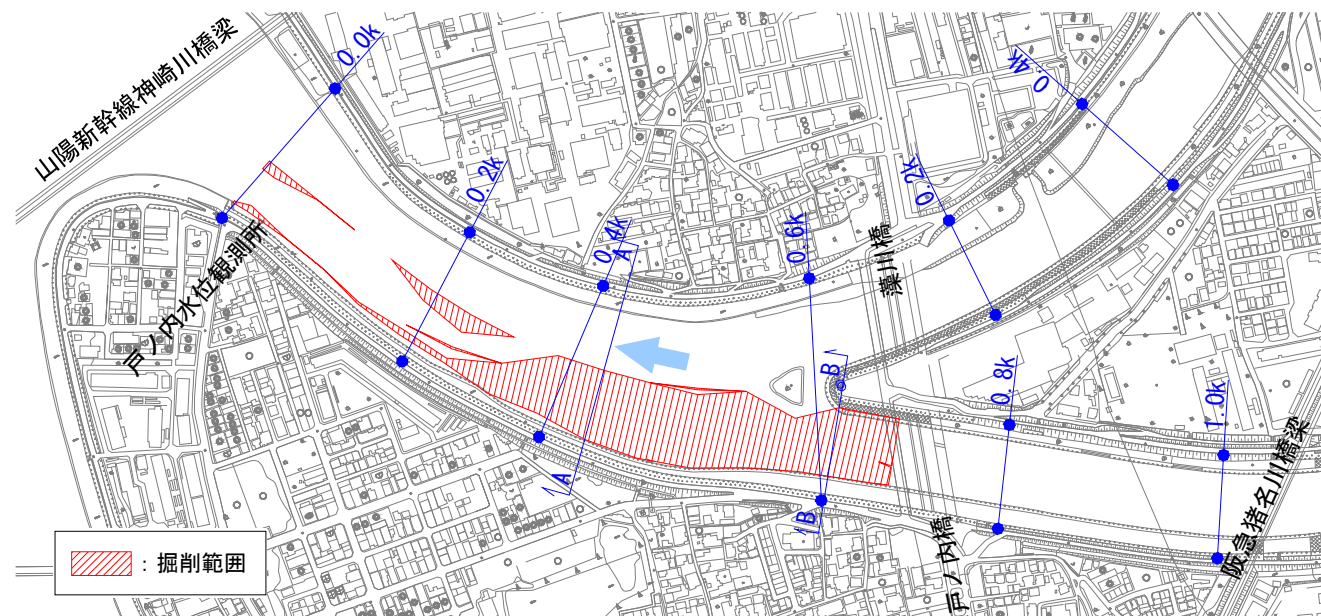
戸ノ内(H24 工事)地区 平面図
